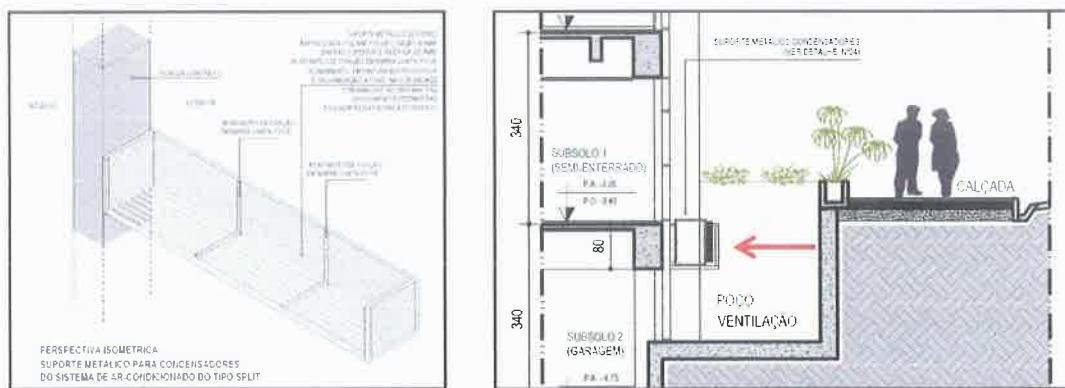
Recortes prancha ARQ-09. Detalhe dos suportes metálicos para fixação das condensadoras na fachada externa do edifício.
